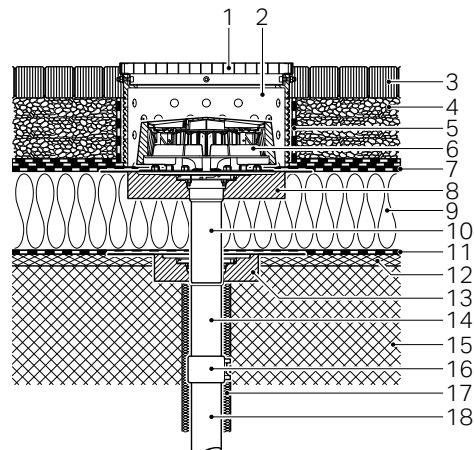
Aufbau Massivdach gedämmt, mit Dampfsperre und Dachabdichtungsfolie, befahrbar
